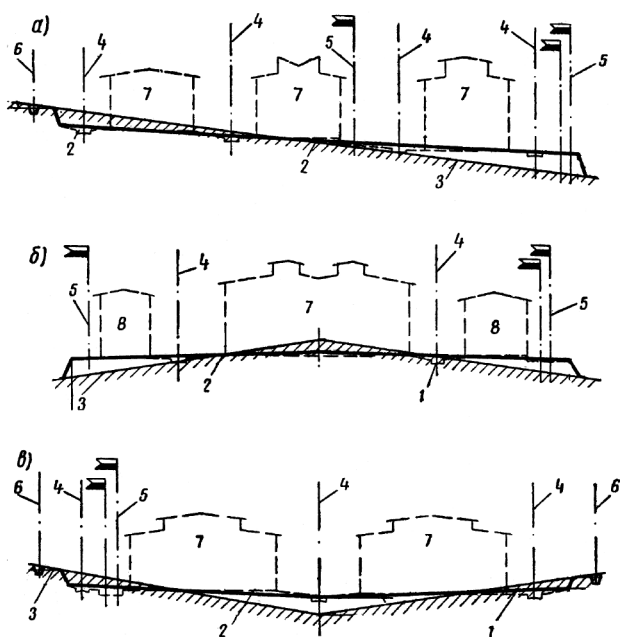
Безтерасові схеми вертикального планування [53]:
